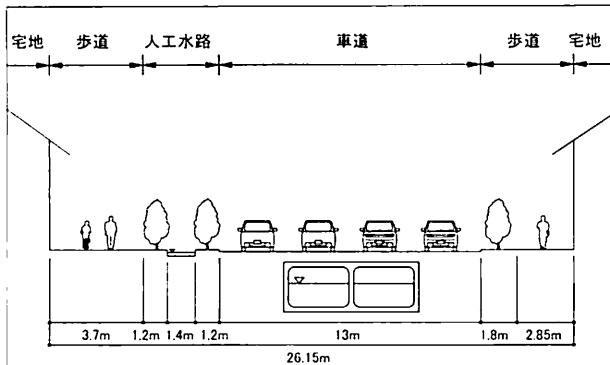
現在の黒門川断面図（道路台帳平面図を基に筆者作成）
